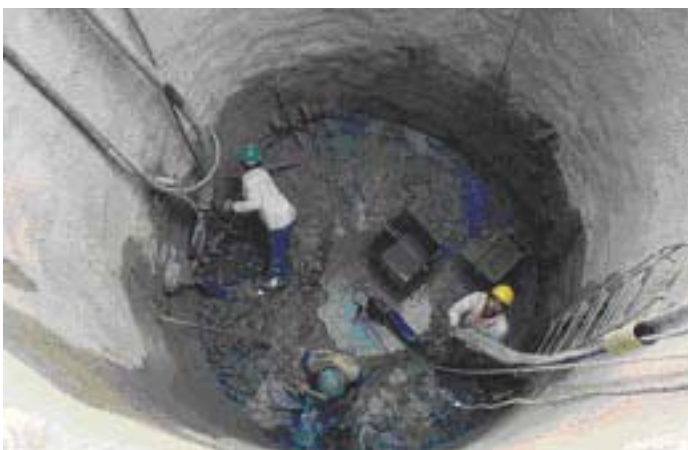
Detalhe do poço em execução atravessando camada de argila orgânica
